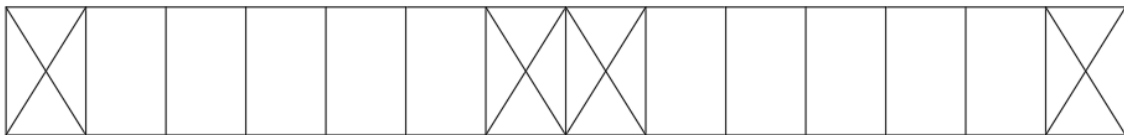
Arriostramientos de fachada. Fuente: Creación propia.
